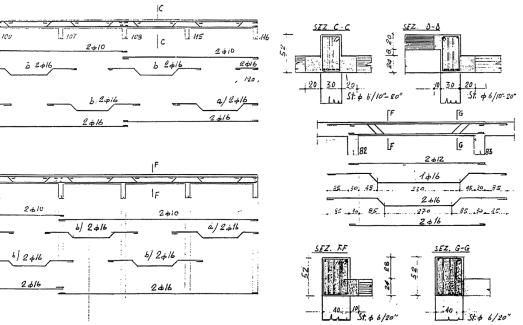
Progetto originale: stralcio di tavola delle travi con dettagli d'armatura.
